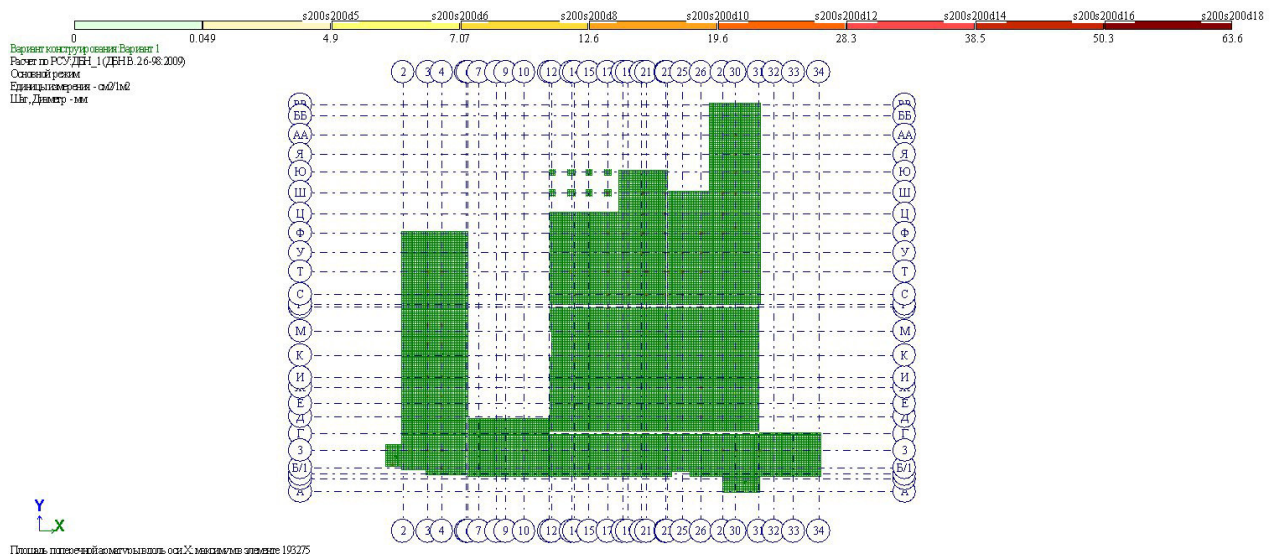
Площадь поперечной арматуры вдоль осі X
